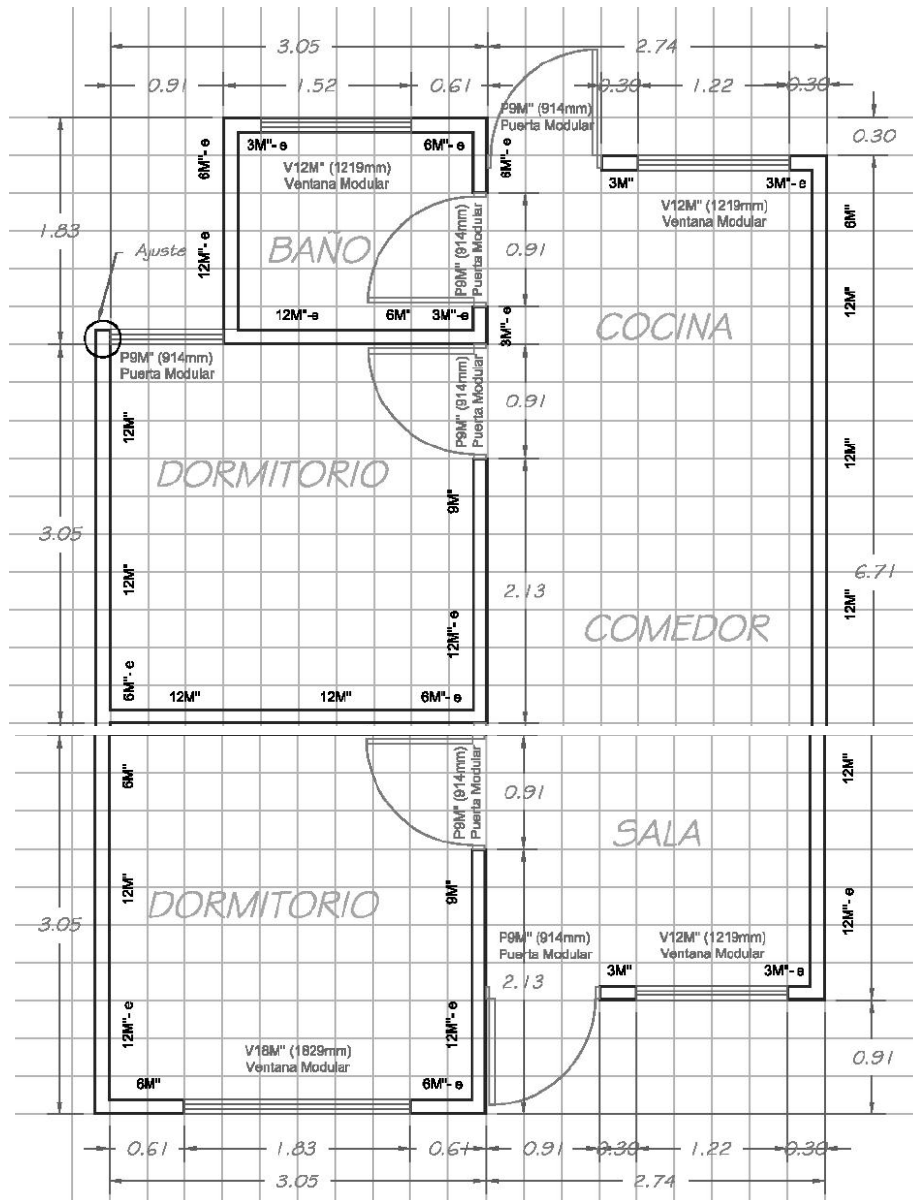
Modulaci3n de vivienda de inter3s social con sistema Steel Framing. Planta sin escala
